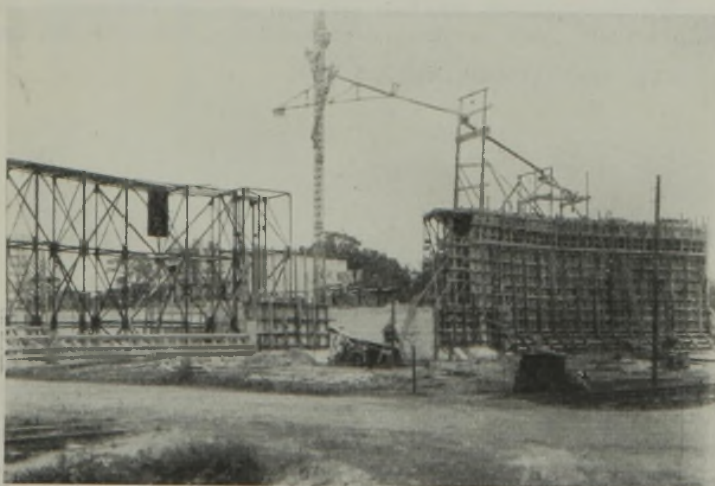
Kanalüberführung Olfen-Selm. Betonieren der Grundbauten. Links ist die Eisenfachwerk-Bewehrung eines Flügels im Anschluß an das nördliche Widerlager zu erkennen.
